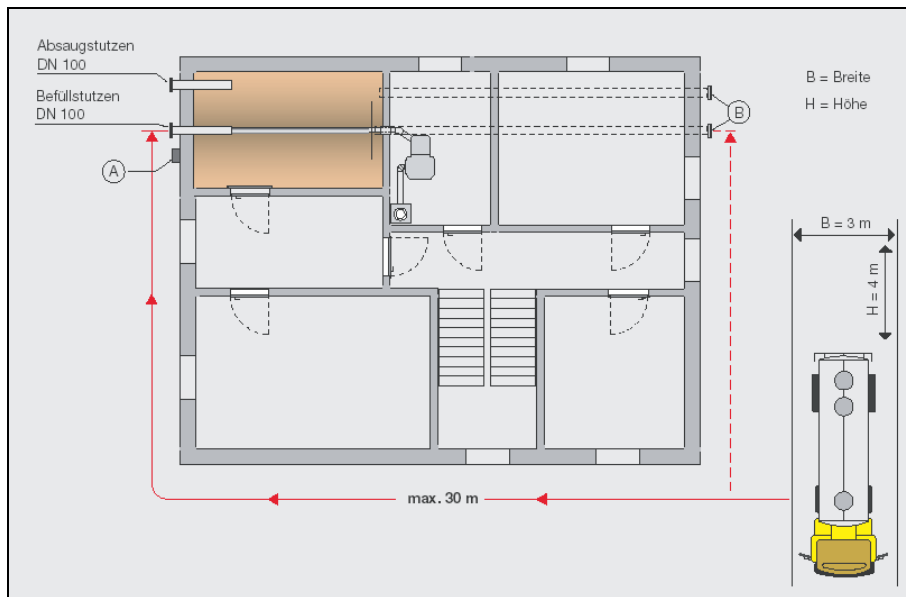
Grundriss zur Lage eines Lagerraum für Holzpellets
